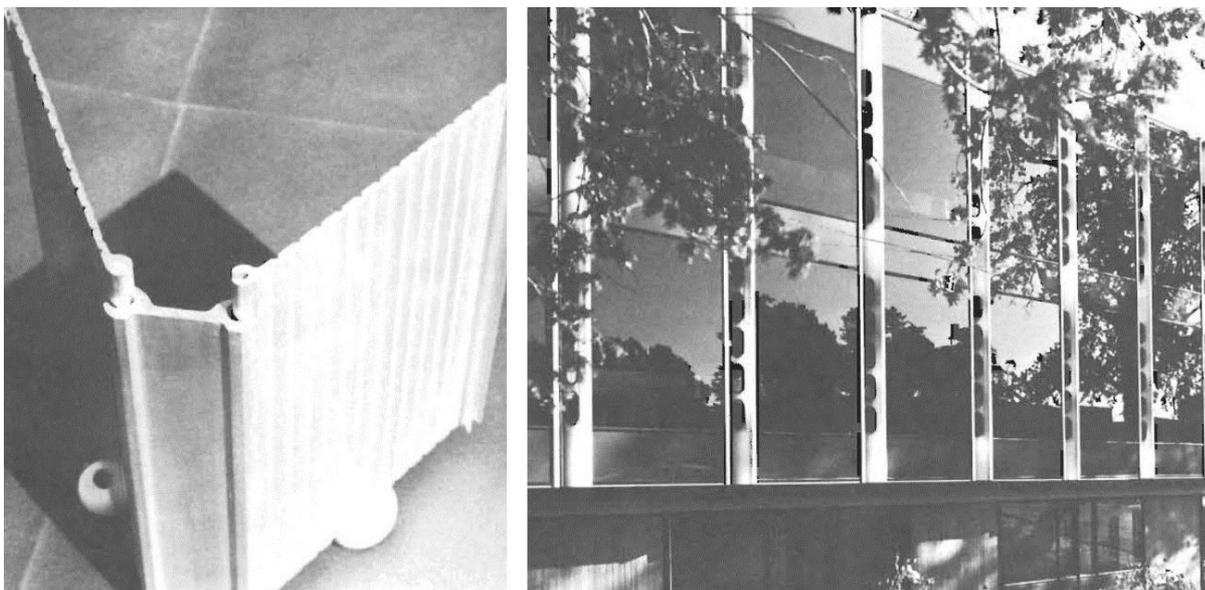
Sistema de painéis de fachada utilizado nas escolas de Sarcelles, Grenoble, St- Egreve a Faverges.
